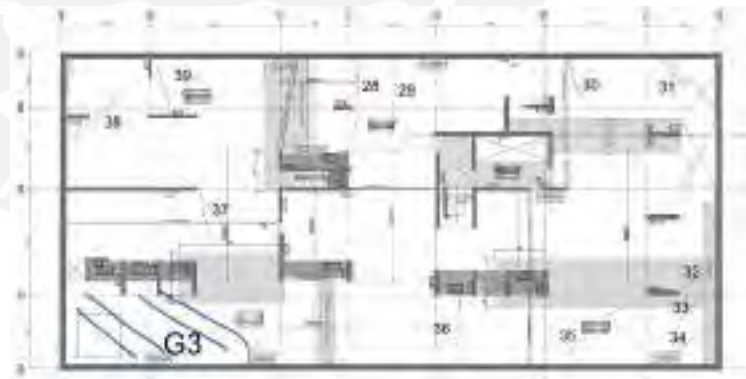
Grupo de Fisuras G3 (3)
